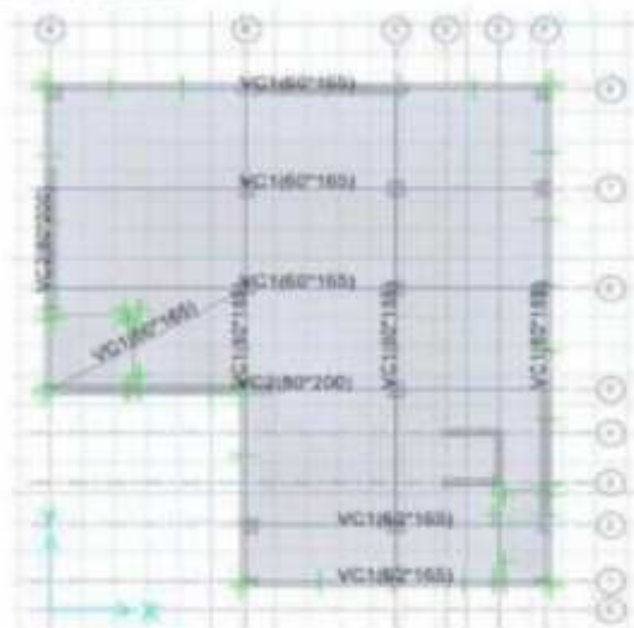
Sección de Vigas de Cimentación adoptadas para el diseño.
